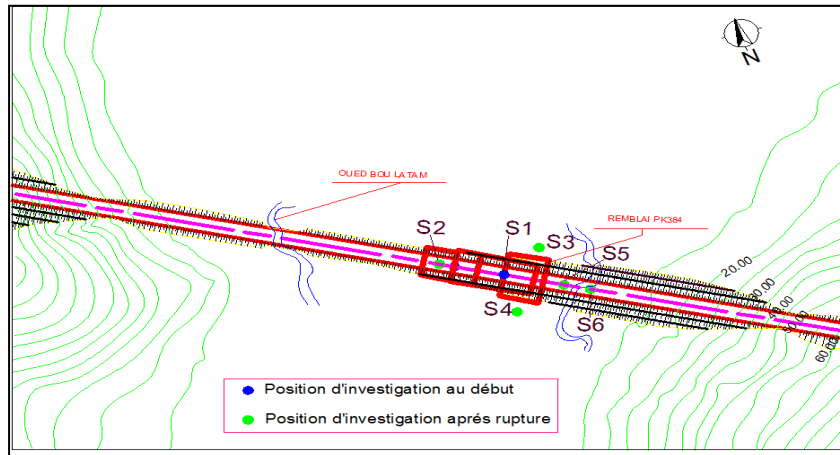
Vue en plan du site et implantation des sondages de reconnaissance
